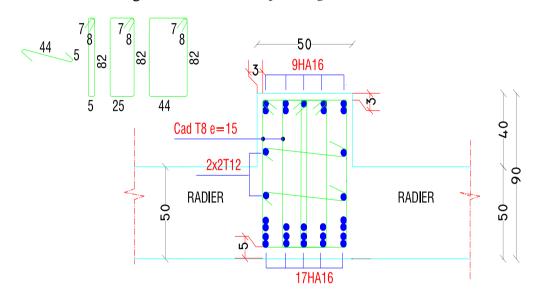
Schéma de ferraillage des nervures Sens YY.
